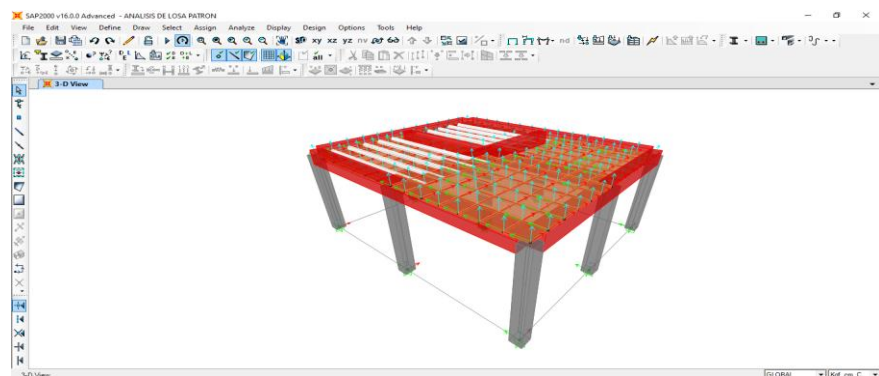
Dibujo en 3D del sistema a porticado con losa aligerada
